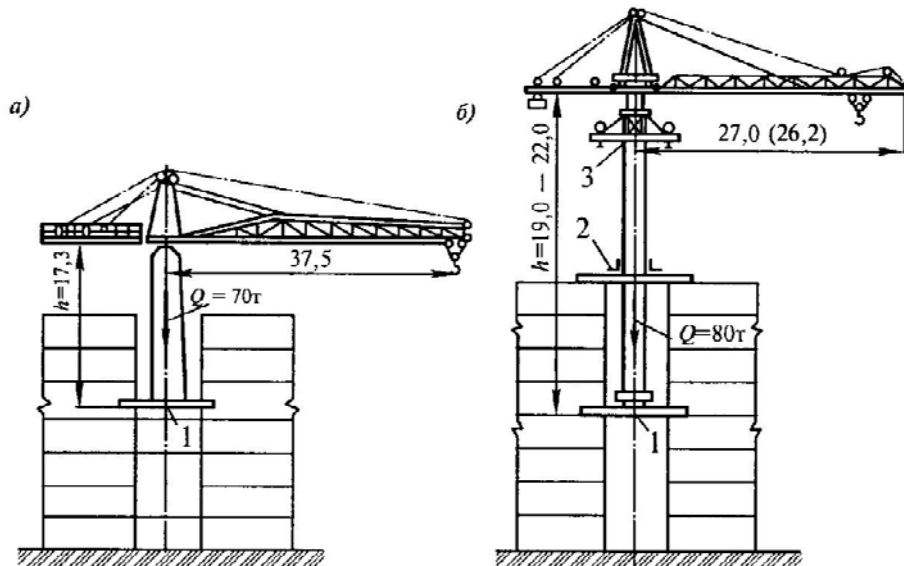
Схемы самоподъемных кранов для монтажа высотных зданий: а — краны типа УБК с защемлением в горизонтальной плоскости; б — краны типа СБК с защемлением в вертикальной плоскости: 1 — нижняя опора; 2 — верхняя опора для восприятия горизонтальных реакций; 3 — подвижная обойма для самоподъема крана на следующую стоянку
